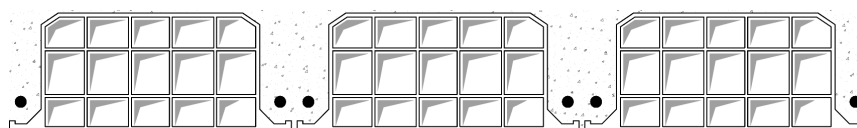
Sezione tipologica del solaio. Floor section types.
